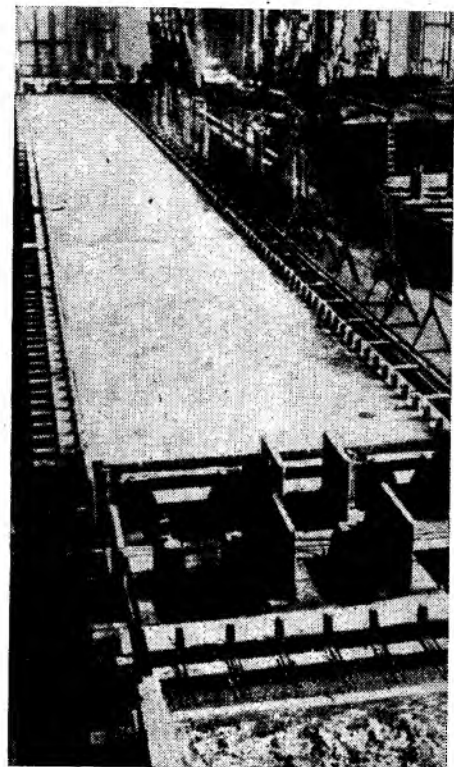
Стенд для двухосной непрерывной намотки канатной или проволочной арматуры
